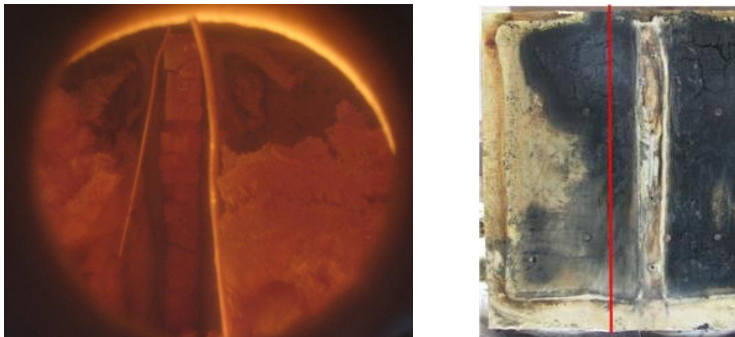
Untersuchung Konstruktionsdetails: Probekörper mit Rahmenelement; links: Blick in den Brandraum kurz nach dem Kollabieren der Schutzschicht; rechts: gereinigter Probekörper nach dem Versuch [INO09]
